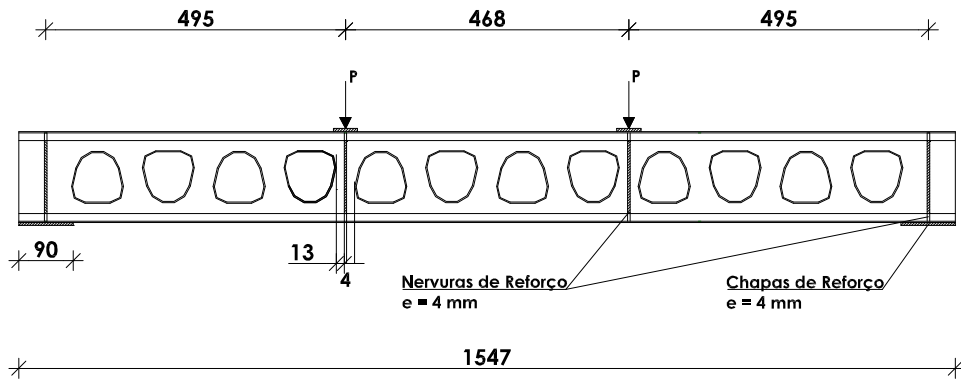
Alçado do ensaio tipo 150×1.5\_Fyy\_Furos (dimensões em mm).
